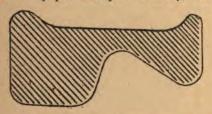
Rail de la 4e Avenue (New-York à Haarlem).
